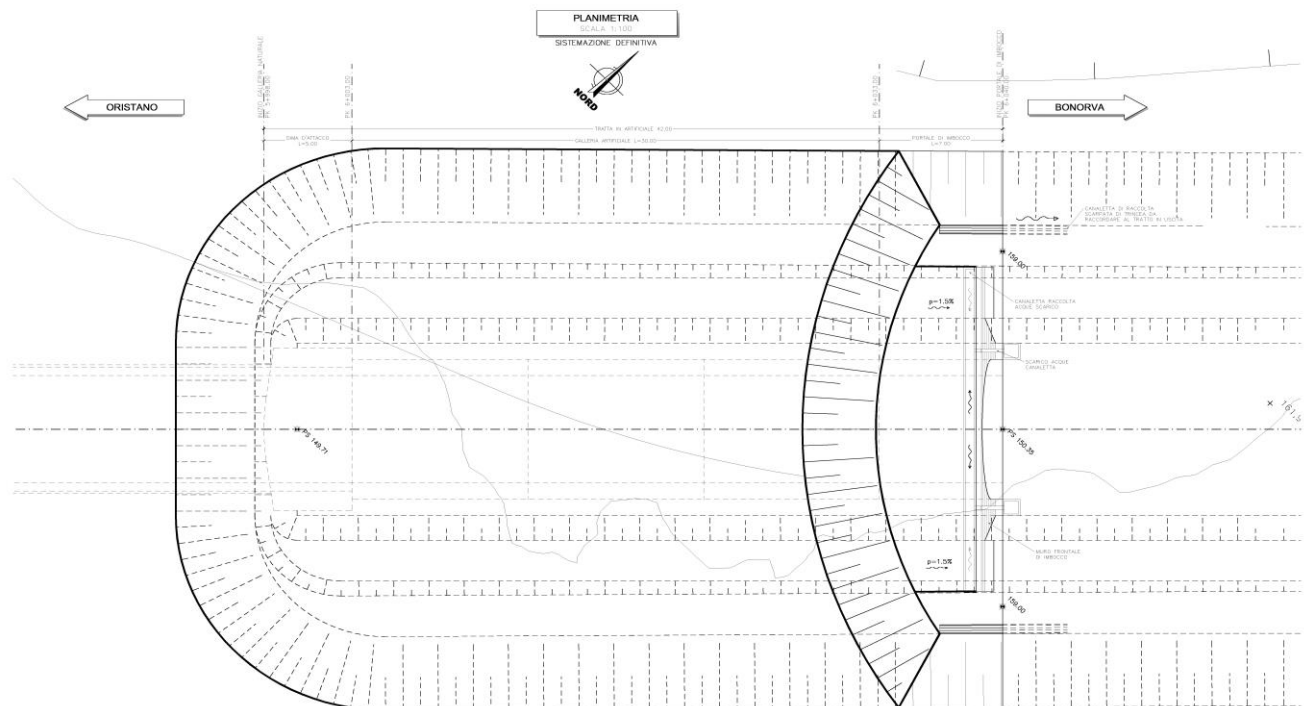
Planimetria di sistemazione definitiva Imbocco lato Bonorva galleria Bauladu
